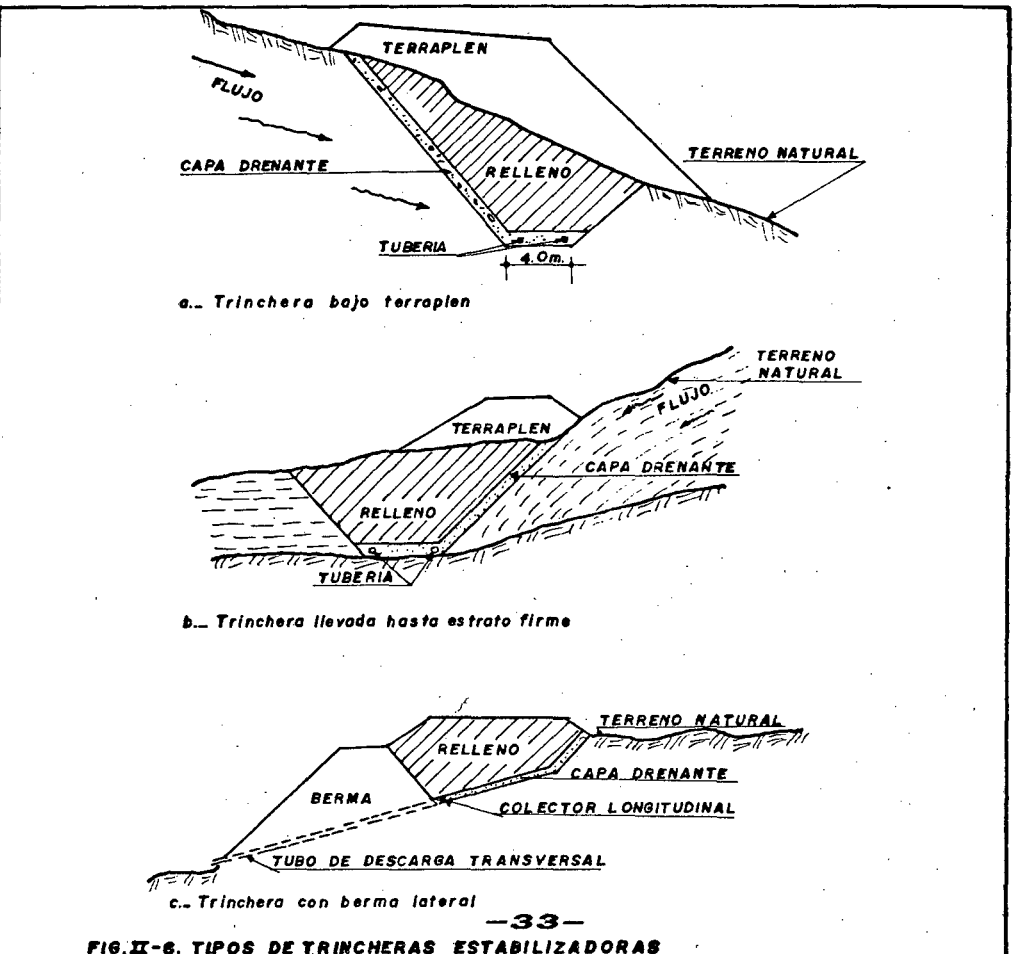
TIPOS DE TRINCHERAS ESTABILIZADORAS
